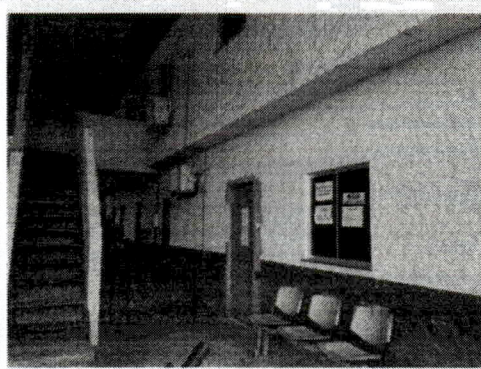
Escada para o pavimento superior, circulação para a copa e cozinha, 03 salas de depósitos e banheiro.
